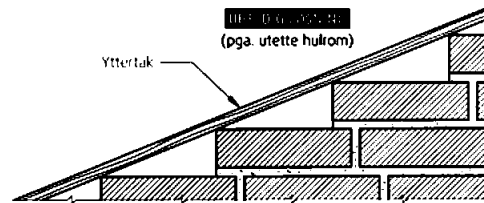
Skillekonstruksjon mellom trapperom og loft.
